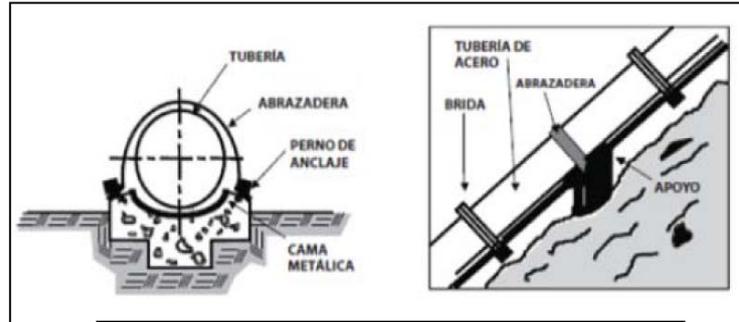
Anclaje tubería de carga
